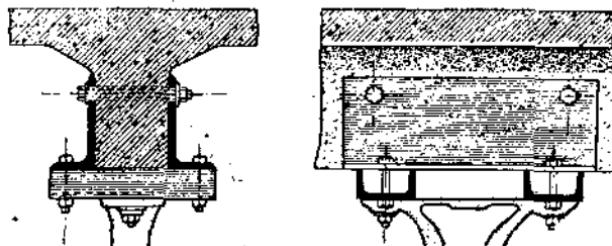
Укрепление подвески на бетонной балке гидроподъемника с помощью швейлеров.
